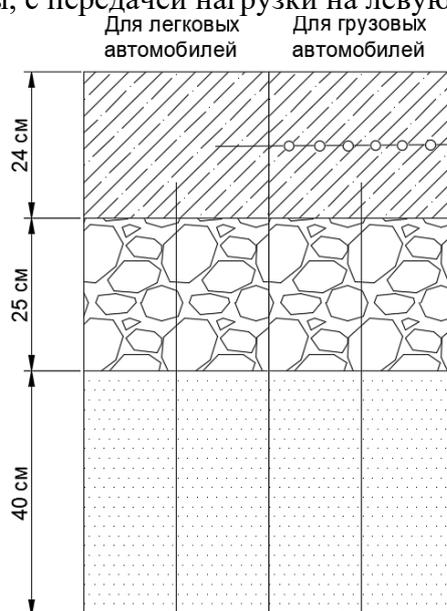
Конструкция дорожных одежд для движения легковых и грузовых авто
